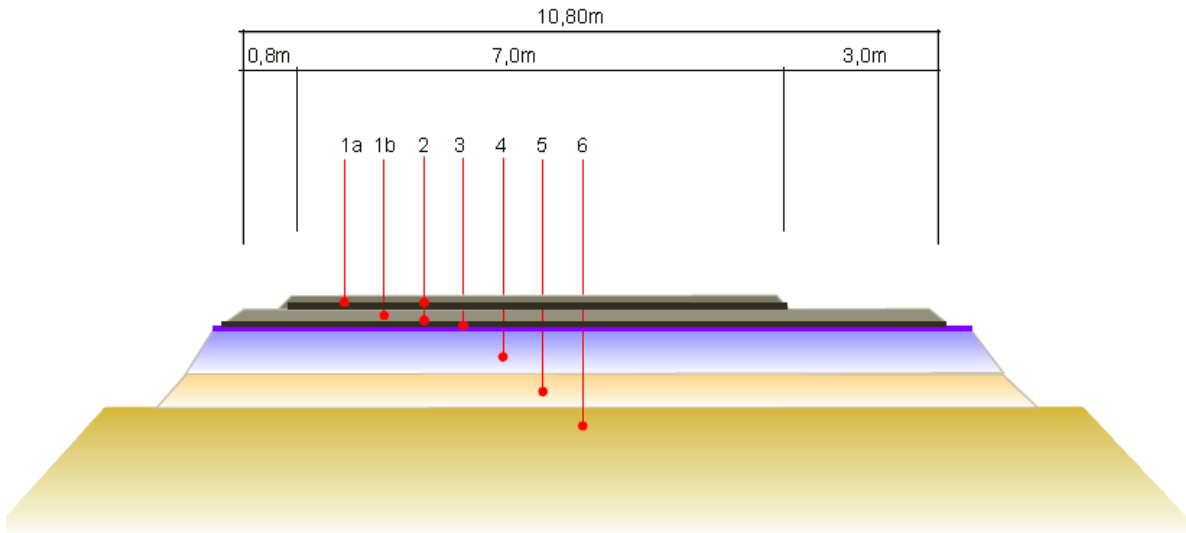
Seção transversal do pavimento projetado original - Duplicação da rodovia BR-020/DF (DNIT, 2008)
